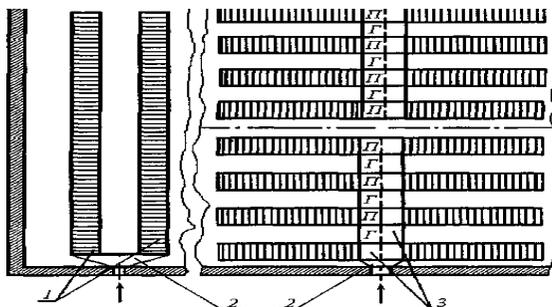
Схема напольно-переносных установок для вентиляции зерна в складах и на площадках: а - установка ГИПЗП-48; б - установка ГИПЗП-55: 1 - деревянные решетки; 2 - переходные патрубки; 3 - проходные (П) и глухие (Г) деревянные щиты
